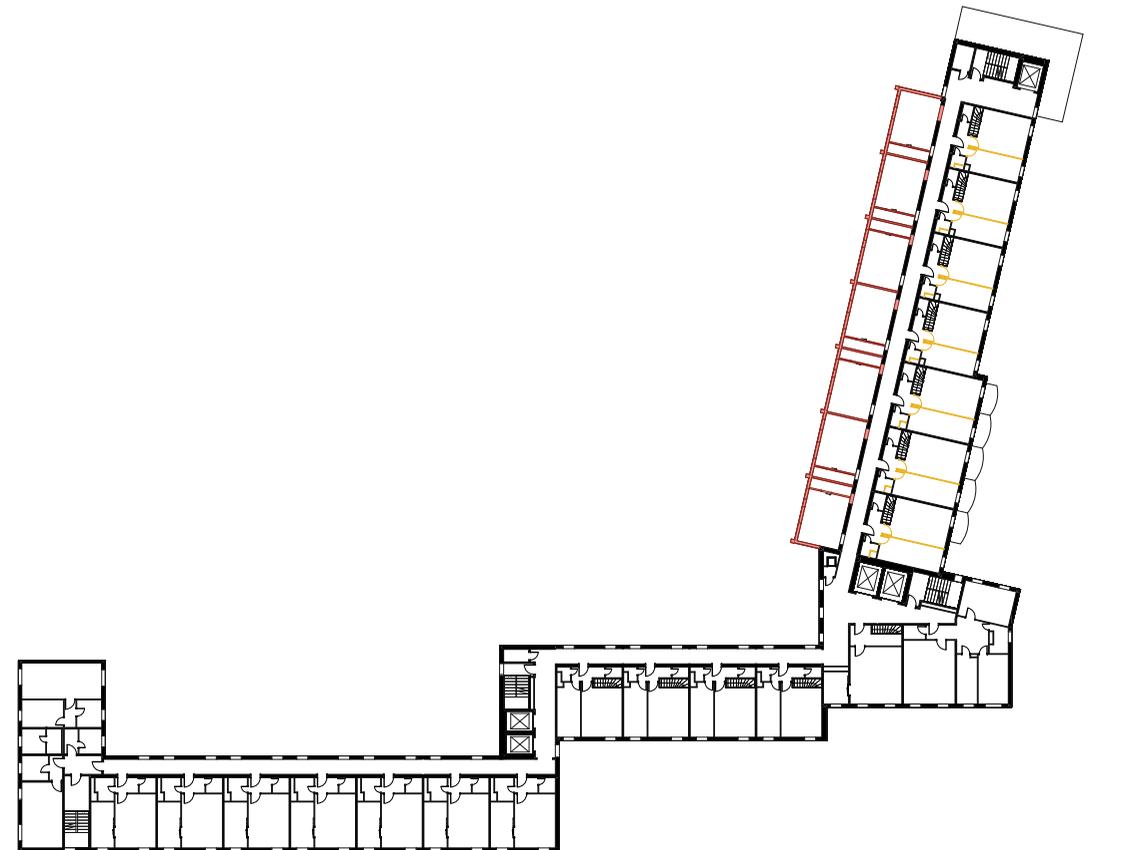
Grundriss. Studio-Apartments & Maisonette-Wohnung Obergeschoss
